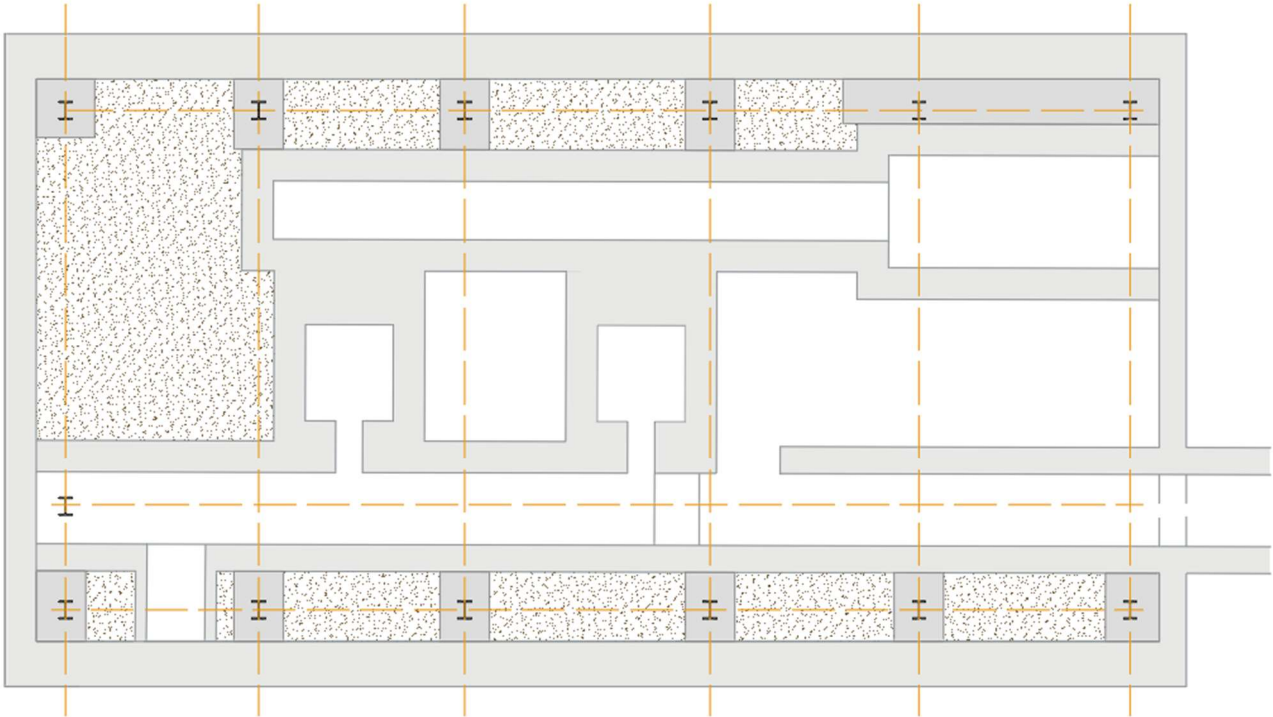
Plinti di fondazione collegati alla struttura monolitica esistente, documento dell'autore
